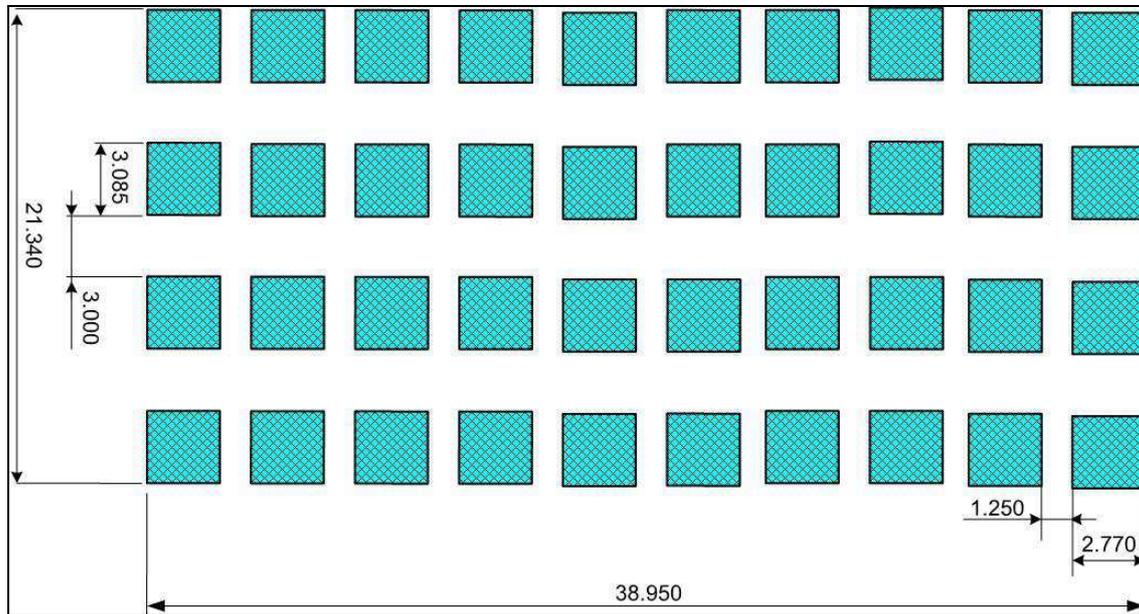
Disposizione planimetrica dei Vaporizzatori.
